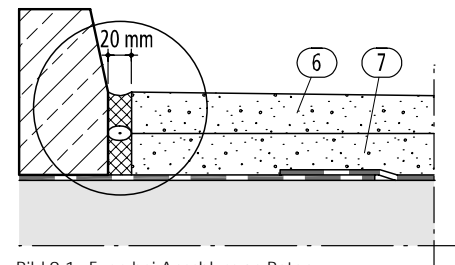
Fuge bei Anschluss an Beton, z.B. Schrammbord
